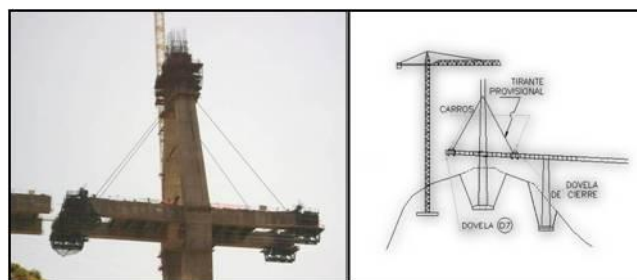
Construcción de dobles volados en pilones 5 y 6
